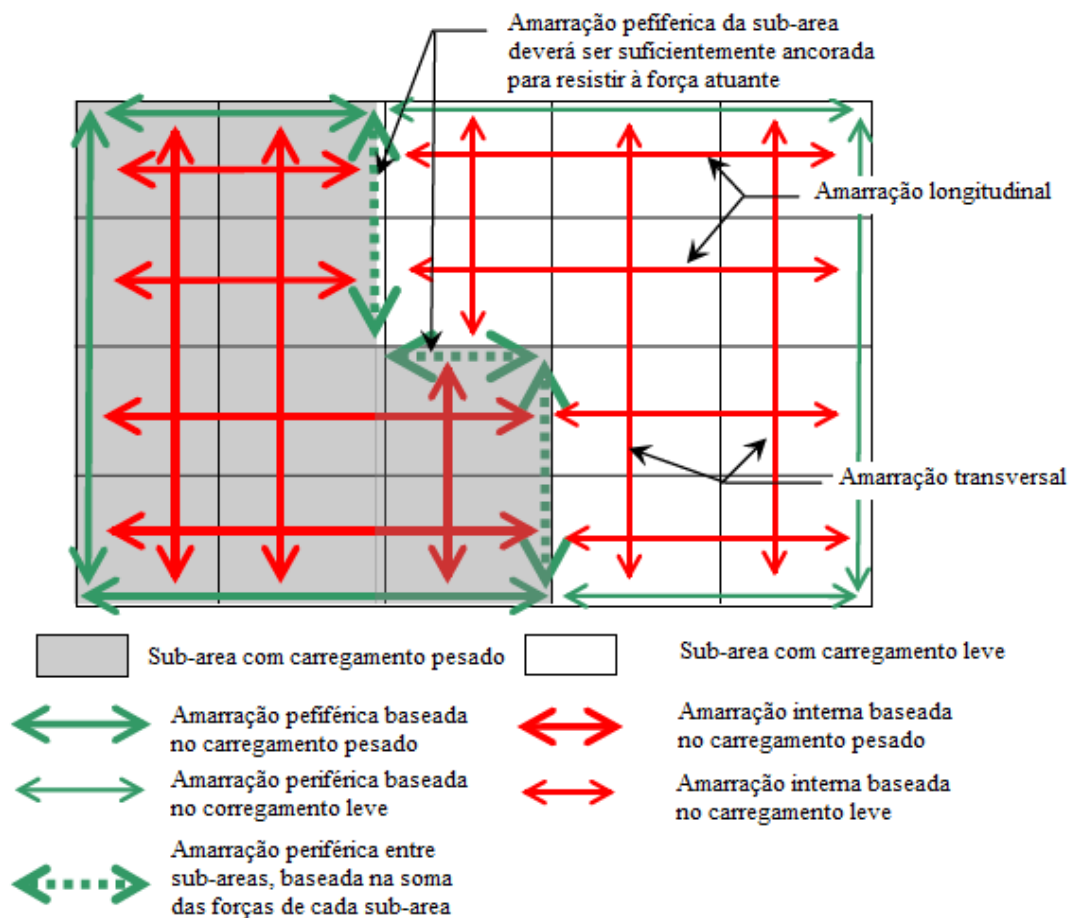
Amarrações se subáreas, periféricas e internas para carregamento não uniforme no mesmo pavimento.
